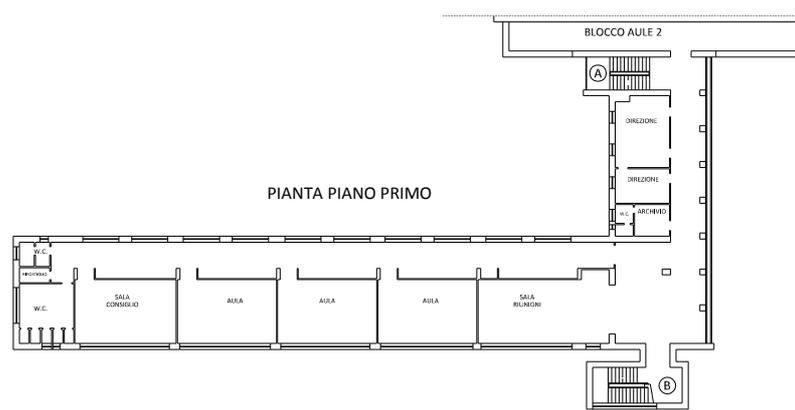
3: Pianta del piano primo (blocco 1).
